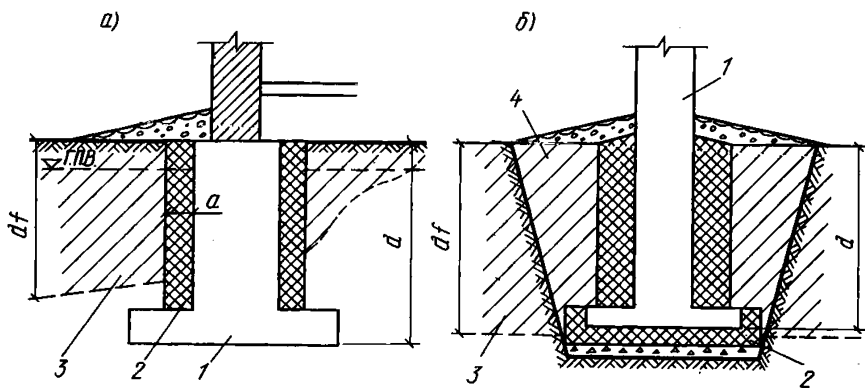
Схема предохранения фундамента от выпучивания посредством устройства рубашки из гидрофобного грунта
